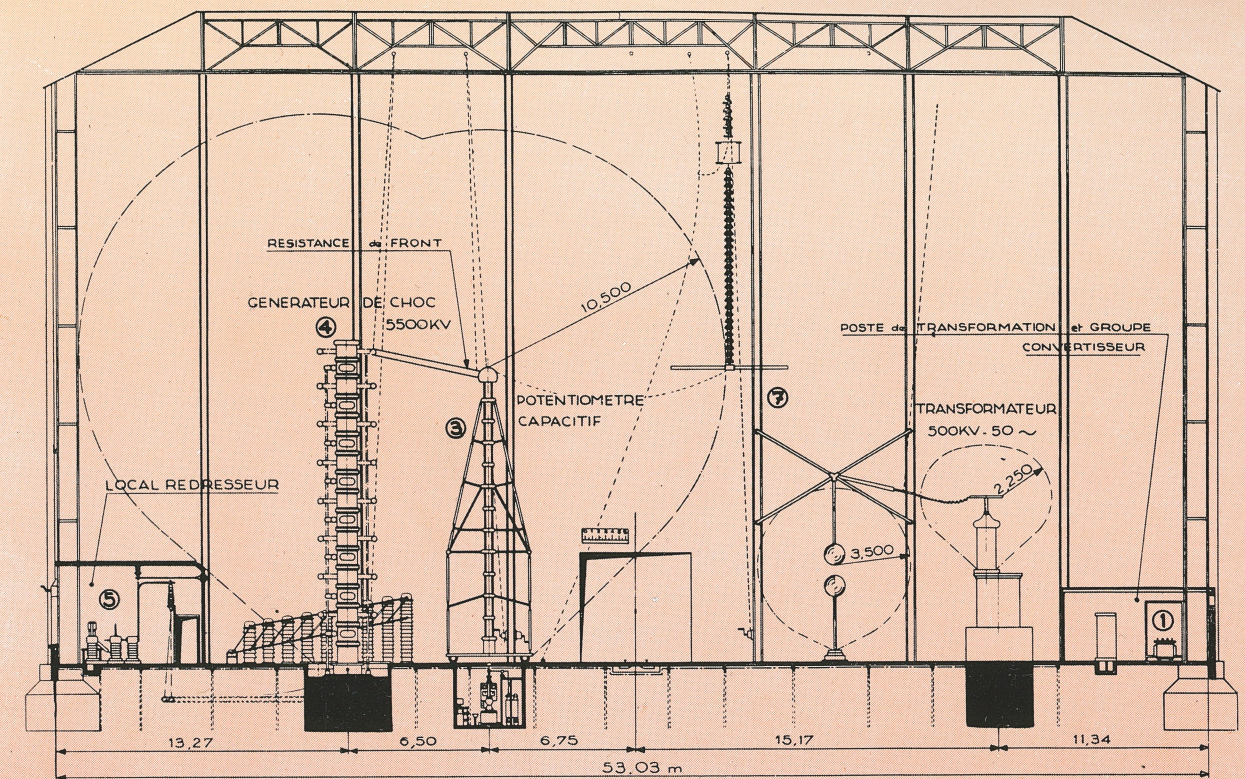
Coupe schématique longitudinale du bâtiment.
